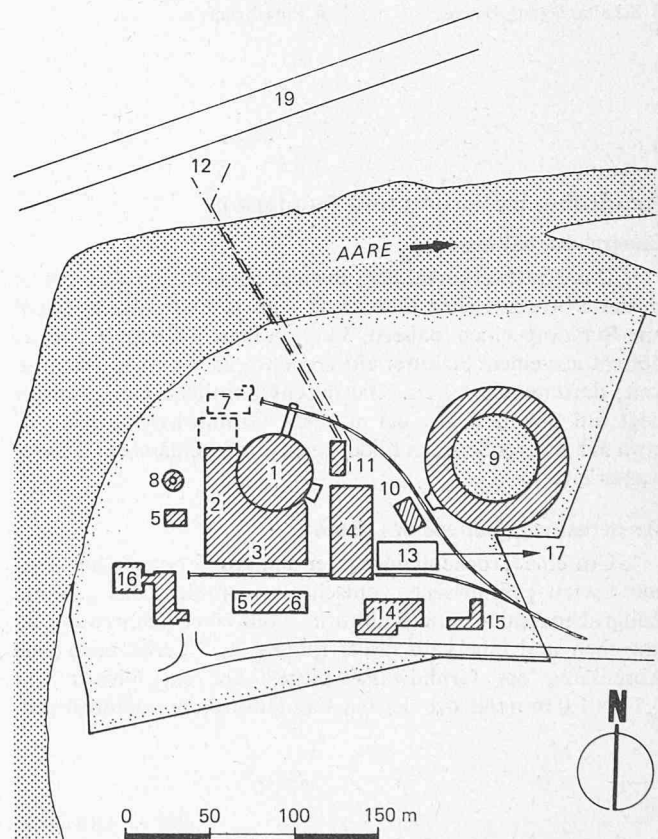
Lageplan des Kernkraftwerkes Gösgen
